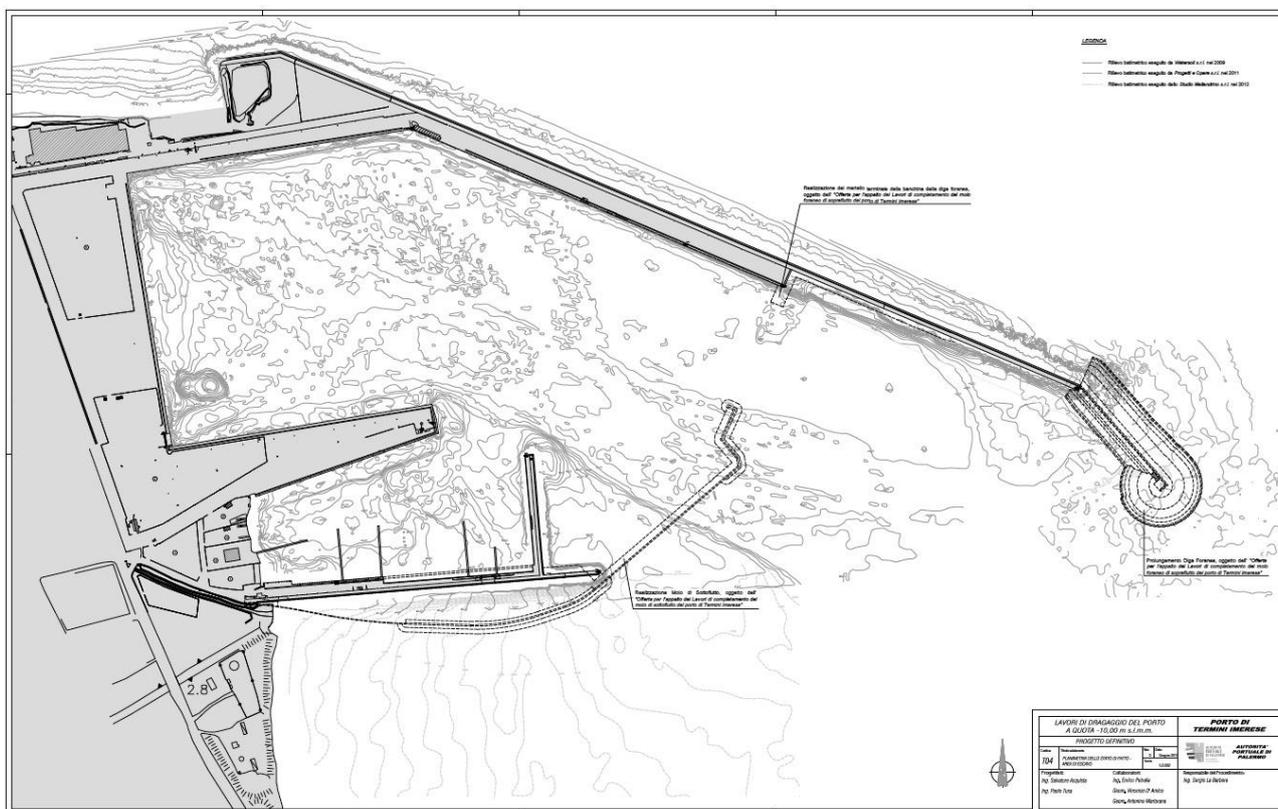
Planimetria generale delle opere in progetto dei moli di sopraflutto e sottoflutto
